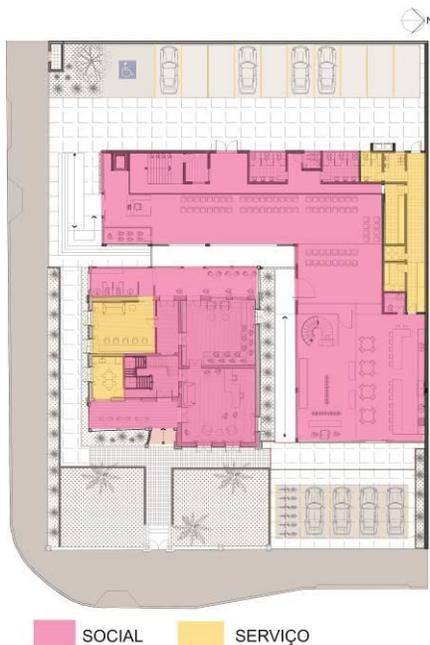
SETORIZAÇÃO PRIMEIRO PAVIMENTO (SEM ESCALA)
